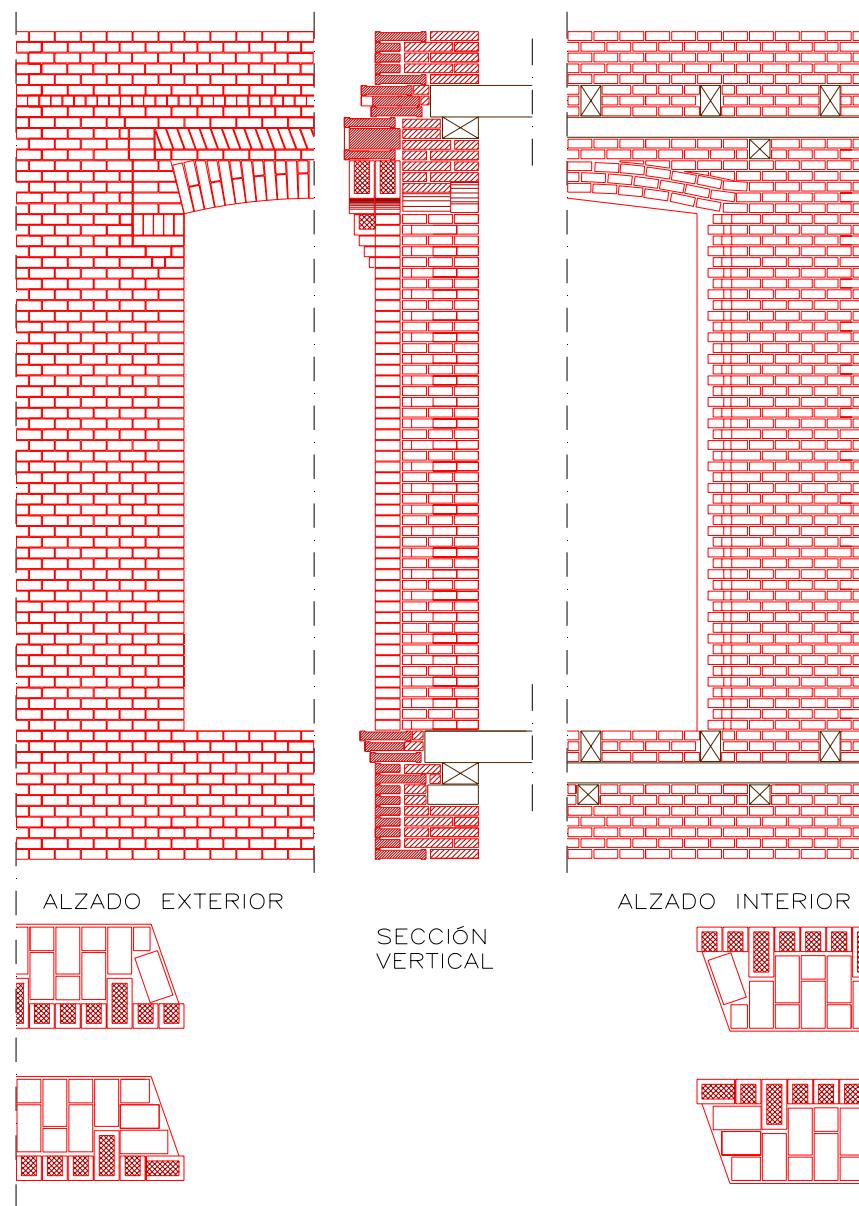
Hueco de fachada tal y como se construían hacia 1905: alzados interior y exterior, secciones horizontales de las dos hiladas y sección vertical
